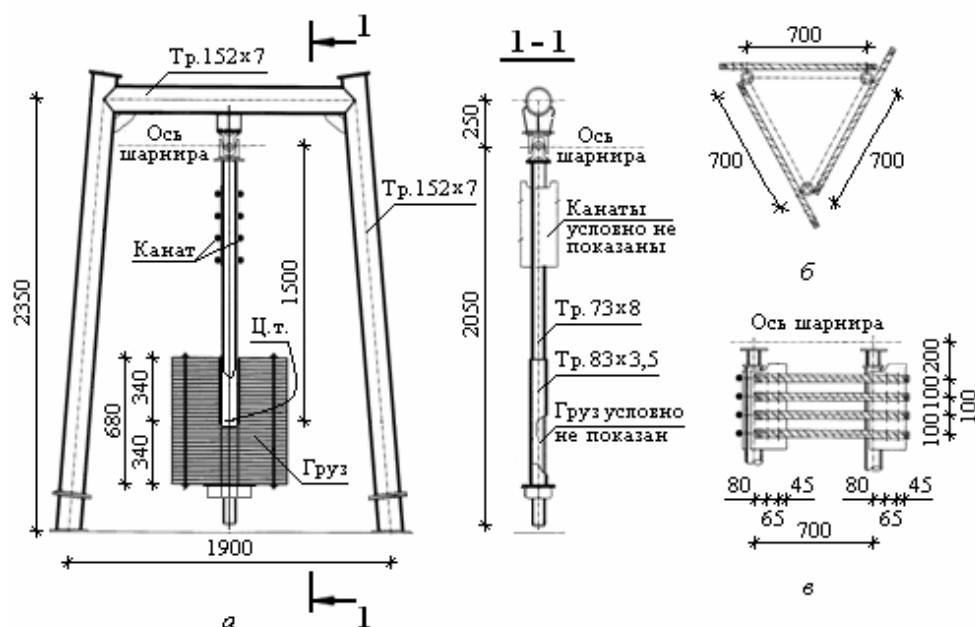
Принципиальная конструктивная схема динамического маятникового гасителя колебаний типа ГК-2: а – разрез по одной из жестких штанг; б – размещение канатов в плане; в – размещение канатов по вертикали
